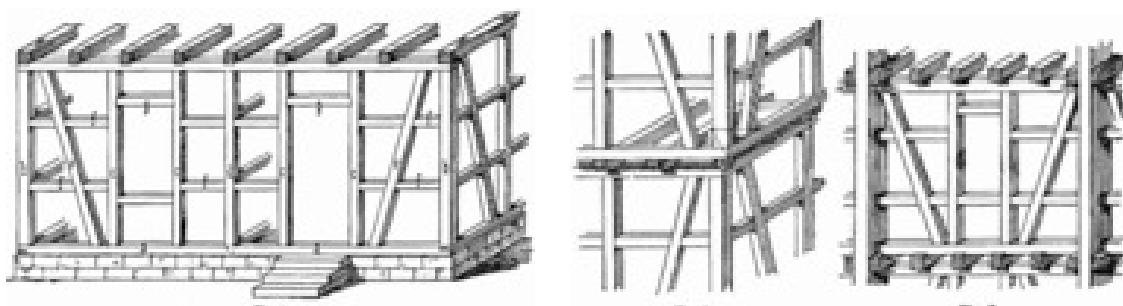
Sistema enxaimel onde os pavimentos se apóiam um sobre o outro com vigas de amarração. Fonte: WIKIPEDIA (2007).
